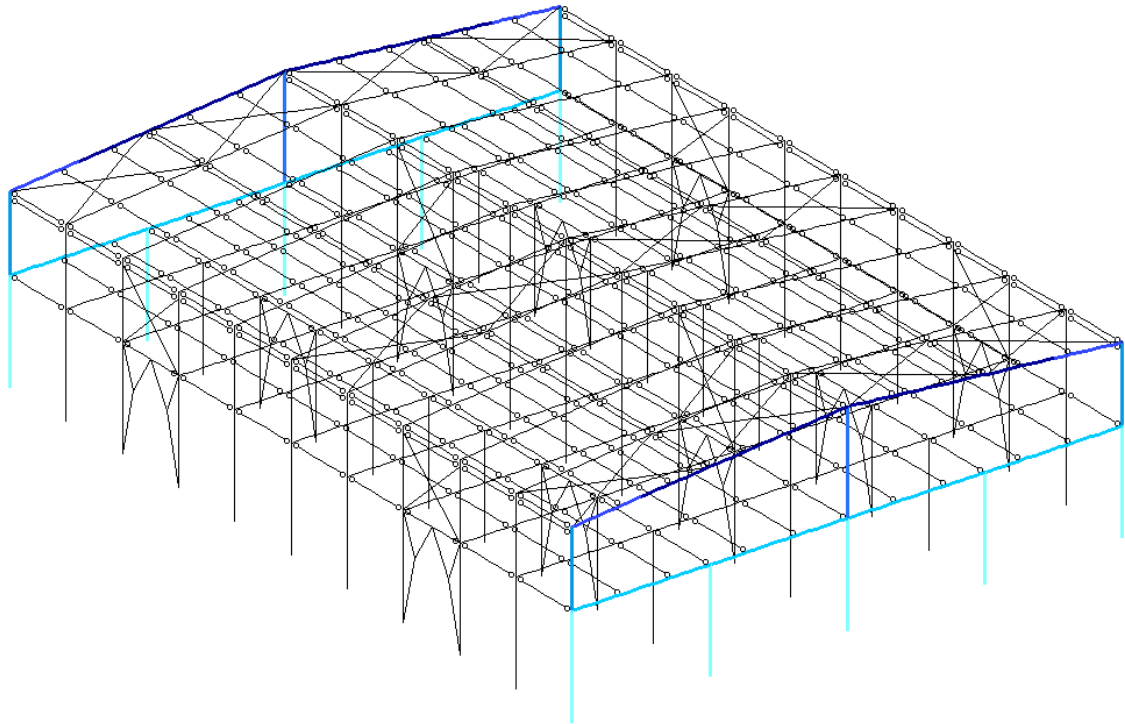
Мозаика ветровых нагрузок на фасад Д-А
